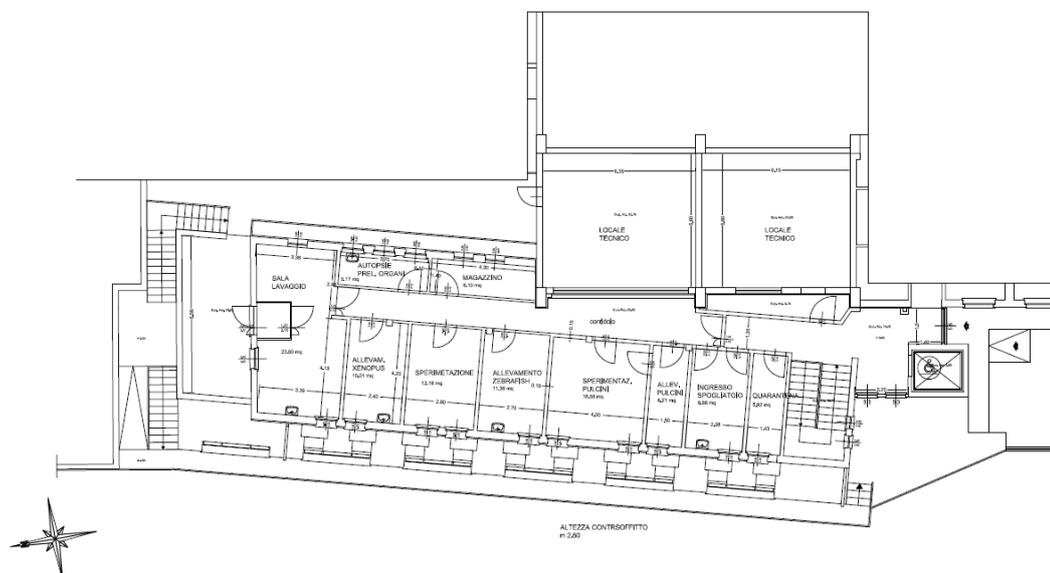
Pianta piano primo dell'edificio RA di Trieste⁴
